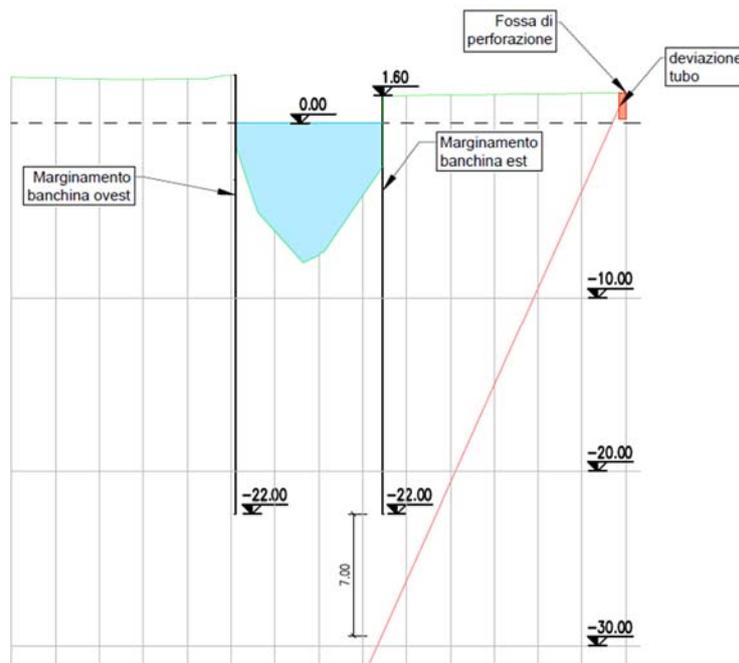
Sezione – dettaglio ingresso Est su via Righi
